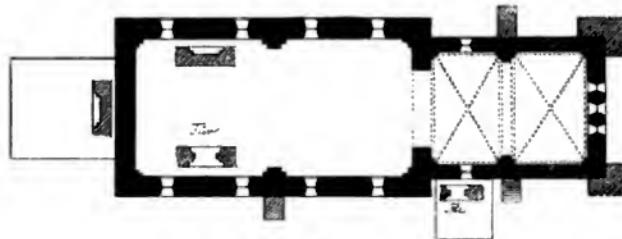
Grundriss der Kirche. 1:100.
